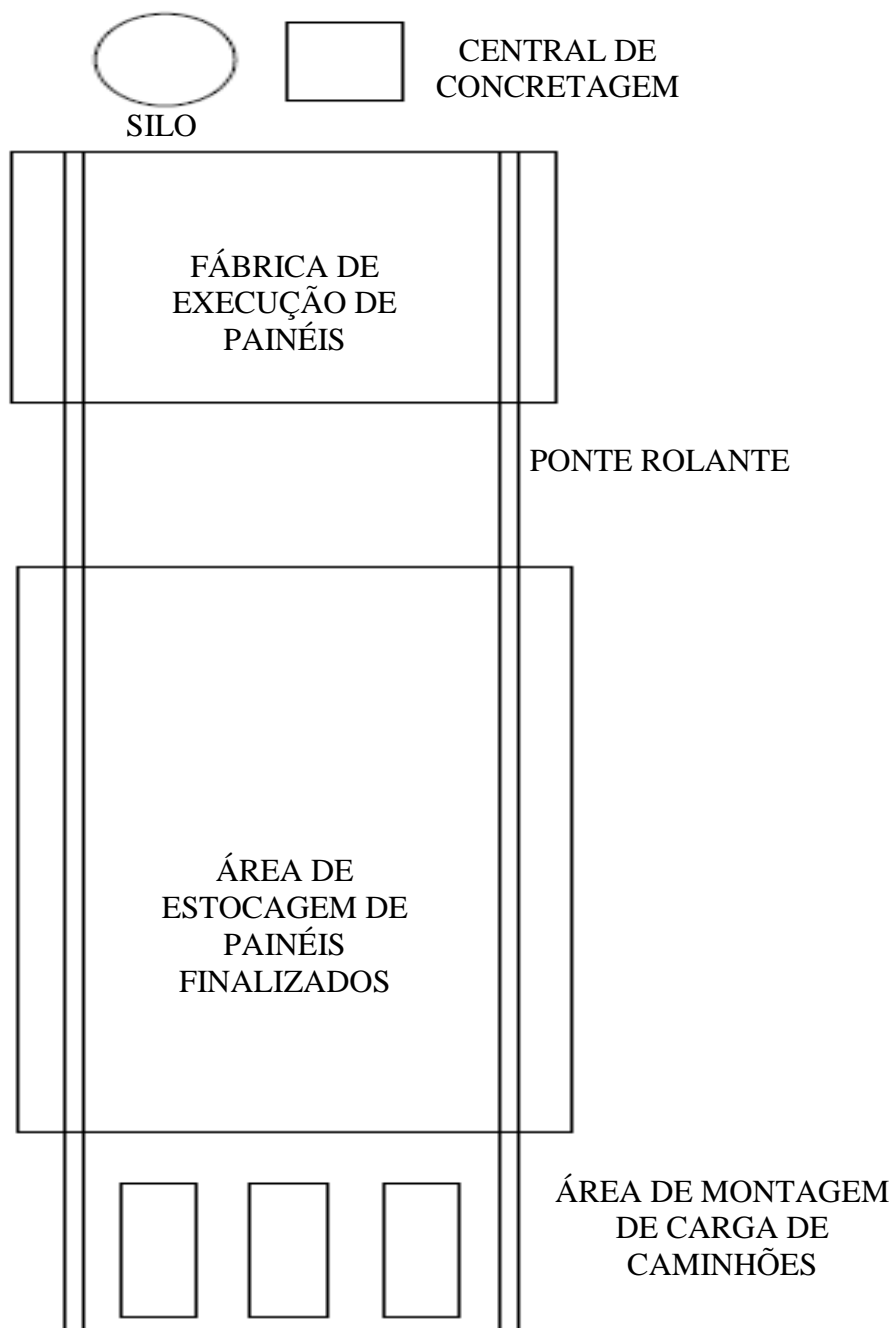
Planta de uma fábrica de painel pré-moldado. Fonte GIOVANNI DONATO (2011)
